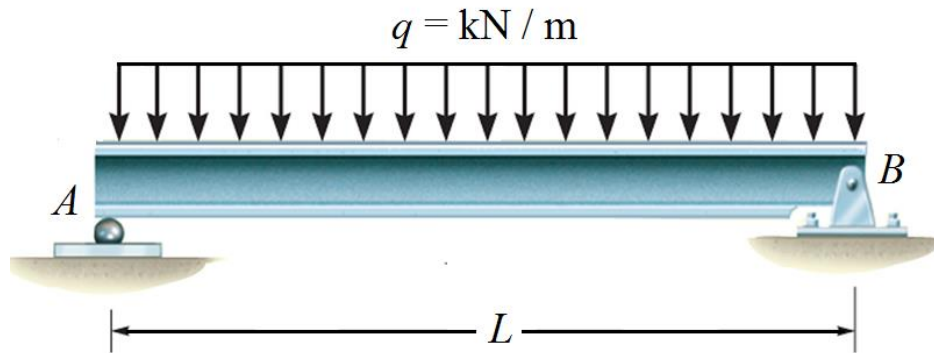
Viga simplemente apoyada y cargada por la fuerza distribuida q . (Hibbeler, 2011).
